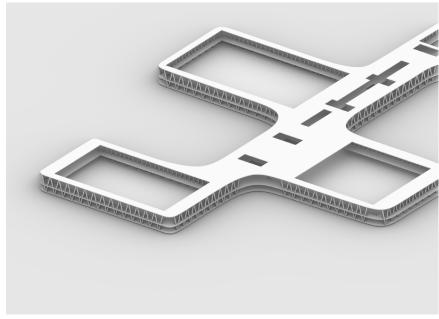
Konstruktionsvariante-Fachwerk-Stahlbeton
